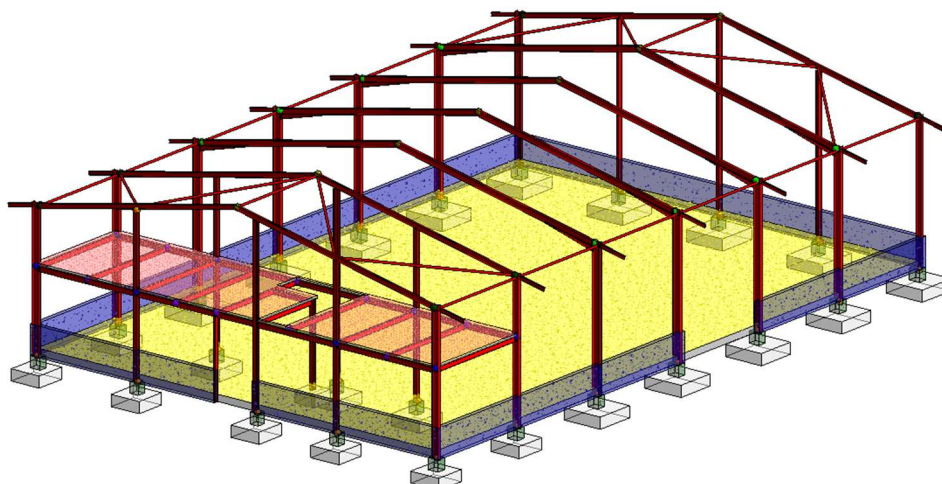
Projeto de estrutura metálica de um pavilhão industrial.
